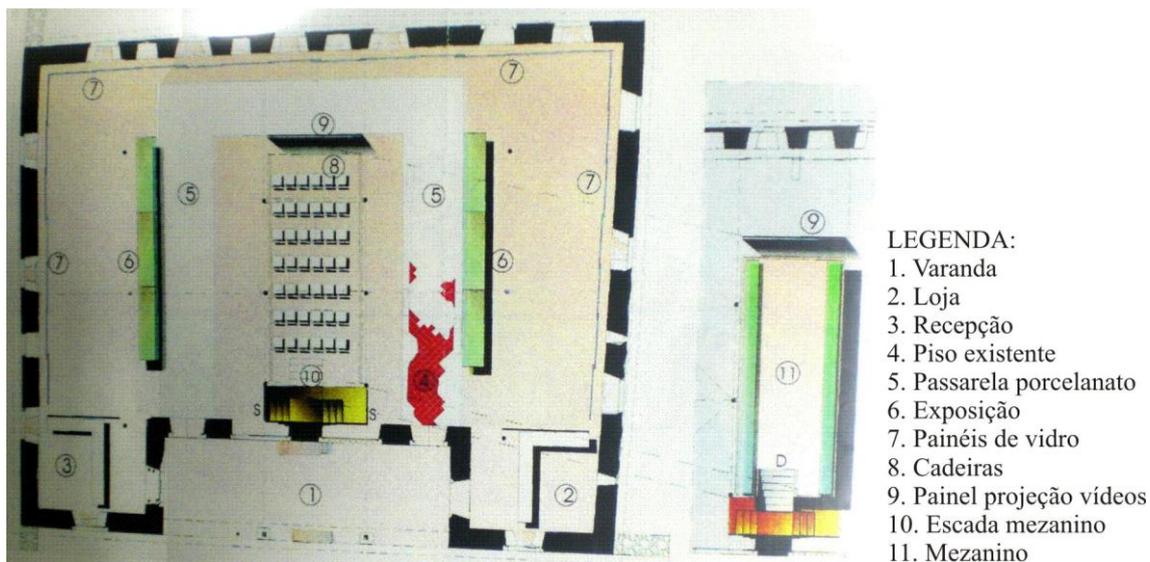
Foto digital das plantas do 1º pavimento e do mezanino - anteprojeto de 1998.
